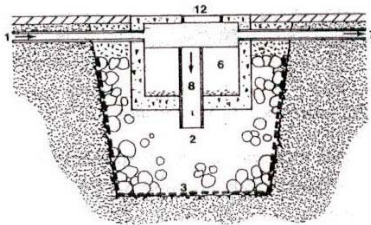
Pozo de infiltración con decantador y rebase sobre el mismo pozo. 1 a 12 como en a y b.
